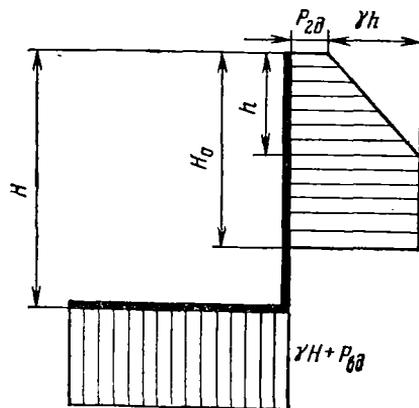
Эпюры вертикального и горизонтального давления бетонной смеси на опалубку
